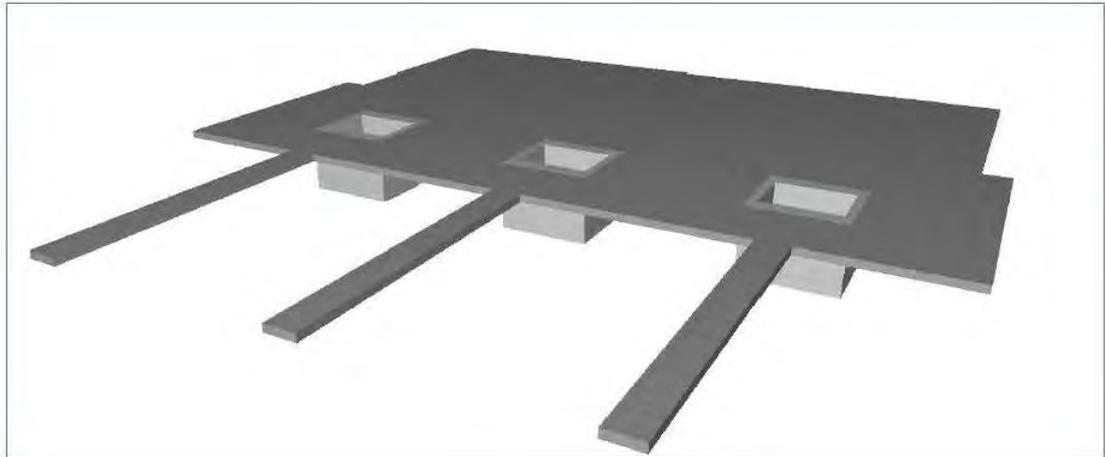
imagen 3D,placa hormigón ,Fuente: propia
